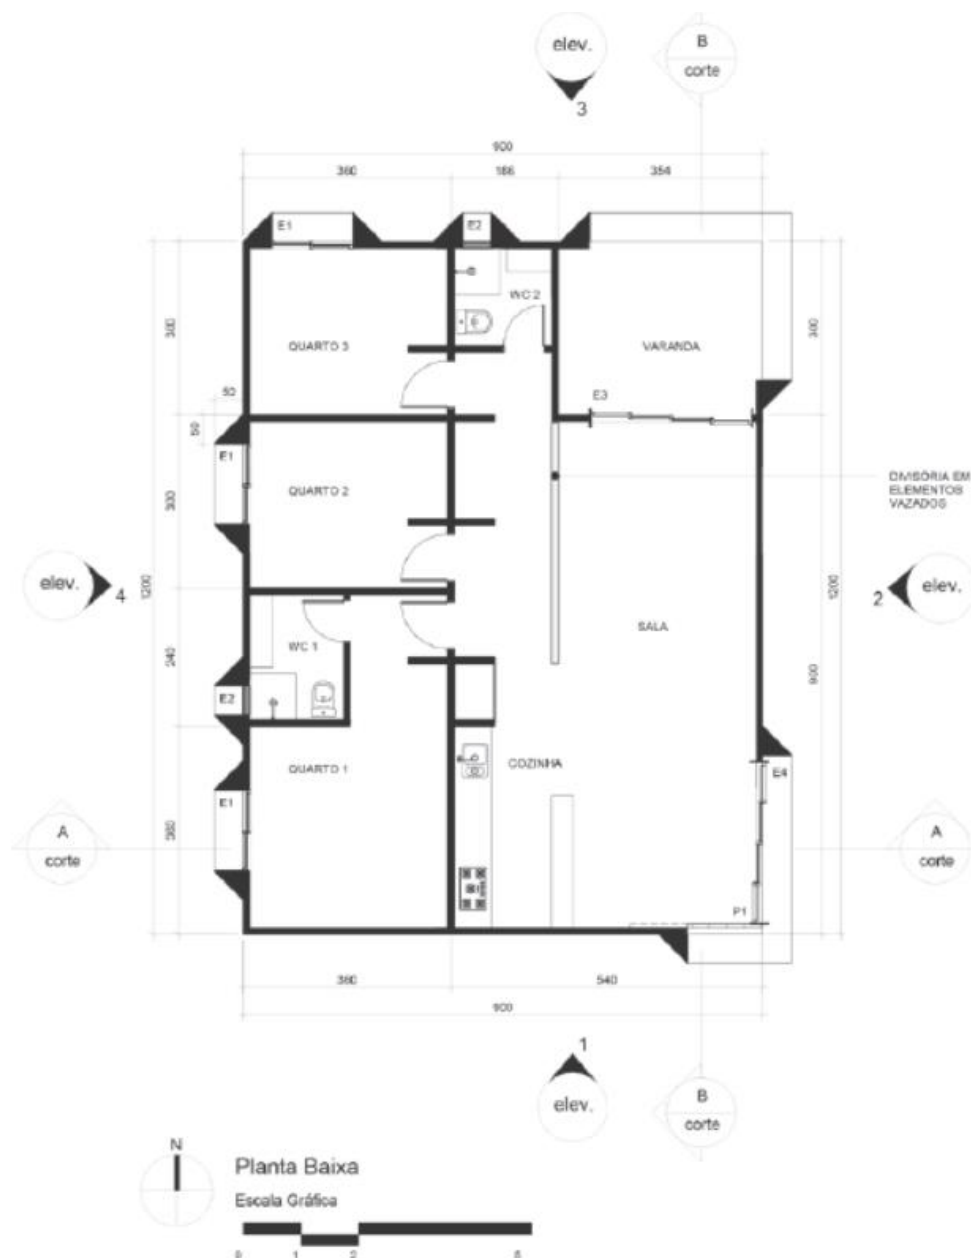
Planta Baixa da Casa Pré-Fabricada, Sudbrack (2017)
